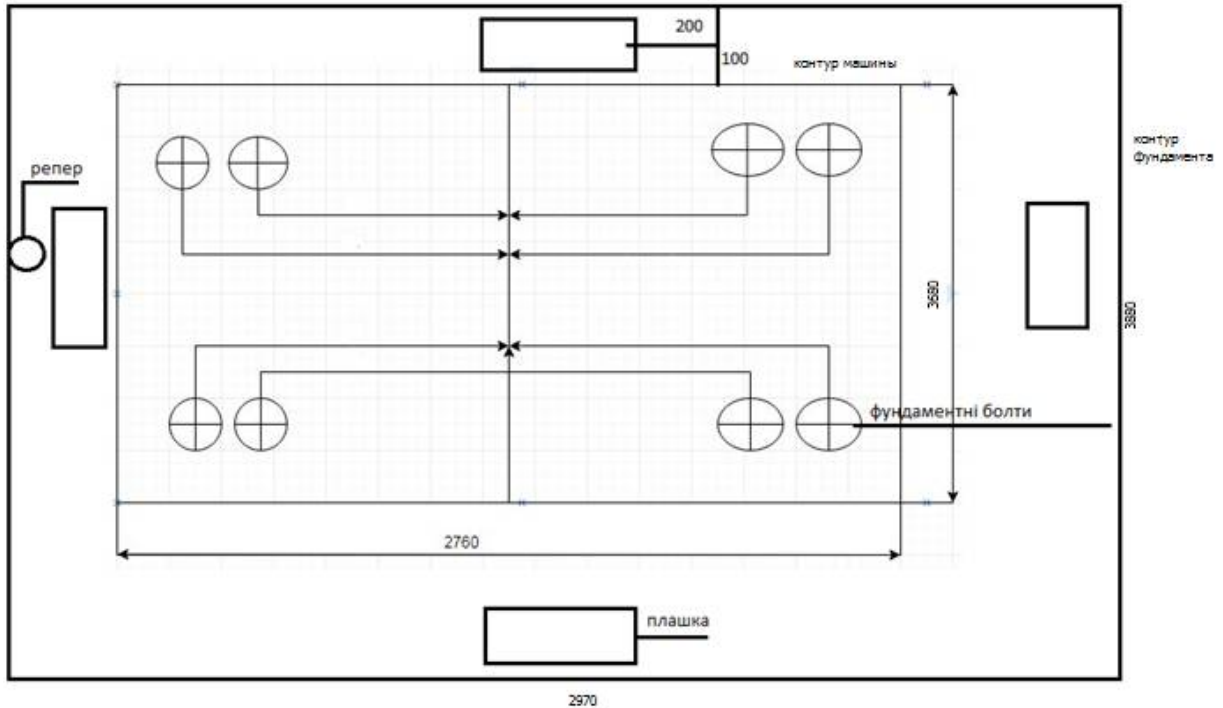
Схема геодезичного обґрунтування монтажу
